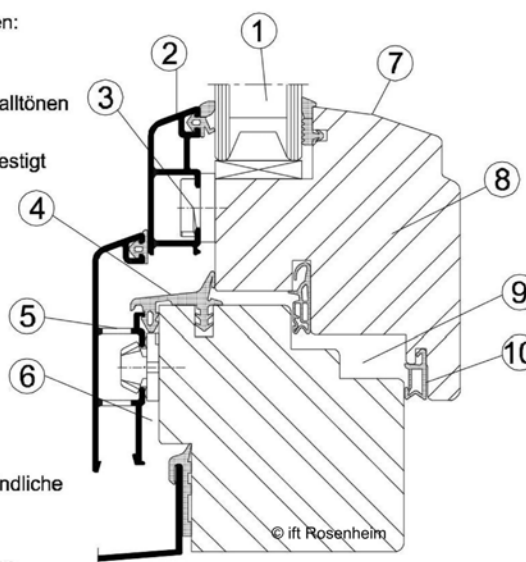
Konstruktionsmerkmale eines modernen Holz-Metallfensters
